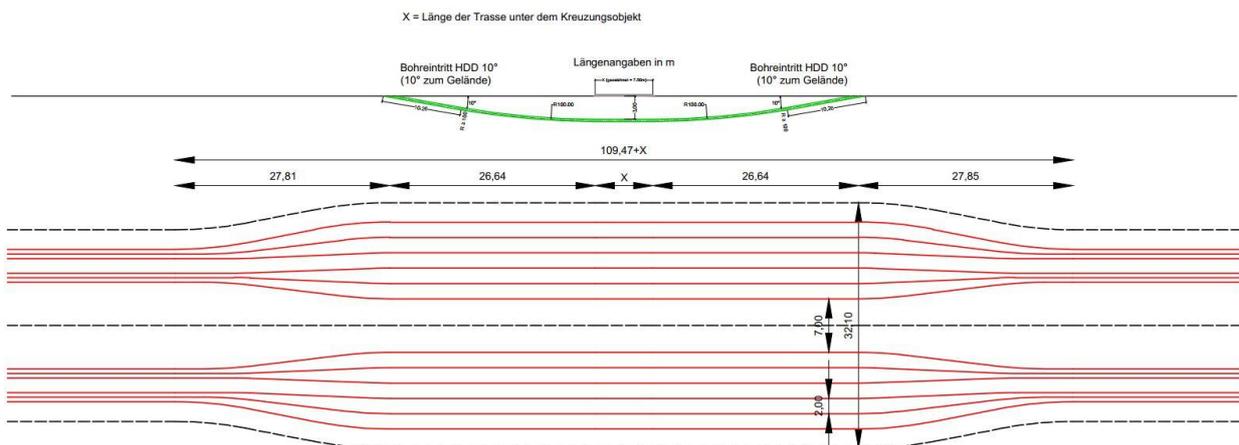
Typische Ausführung einer Straßenquerung, geschlossene Bauweise
